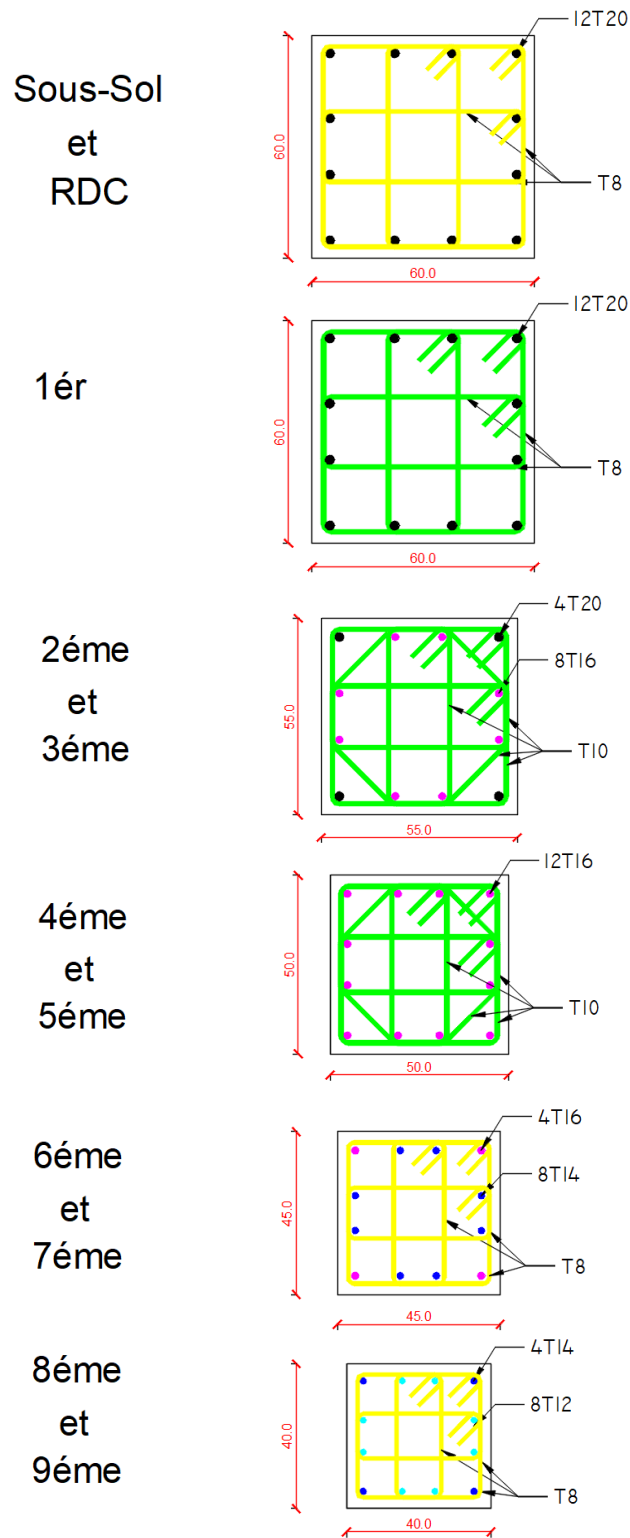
Schéma de ferrailage des poteaux zone nodale.
